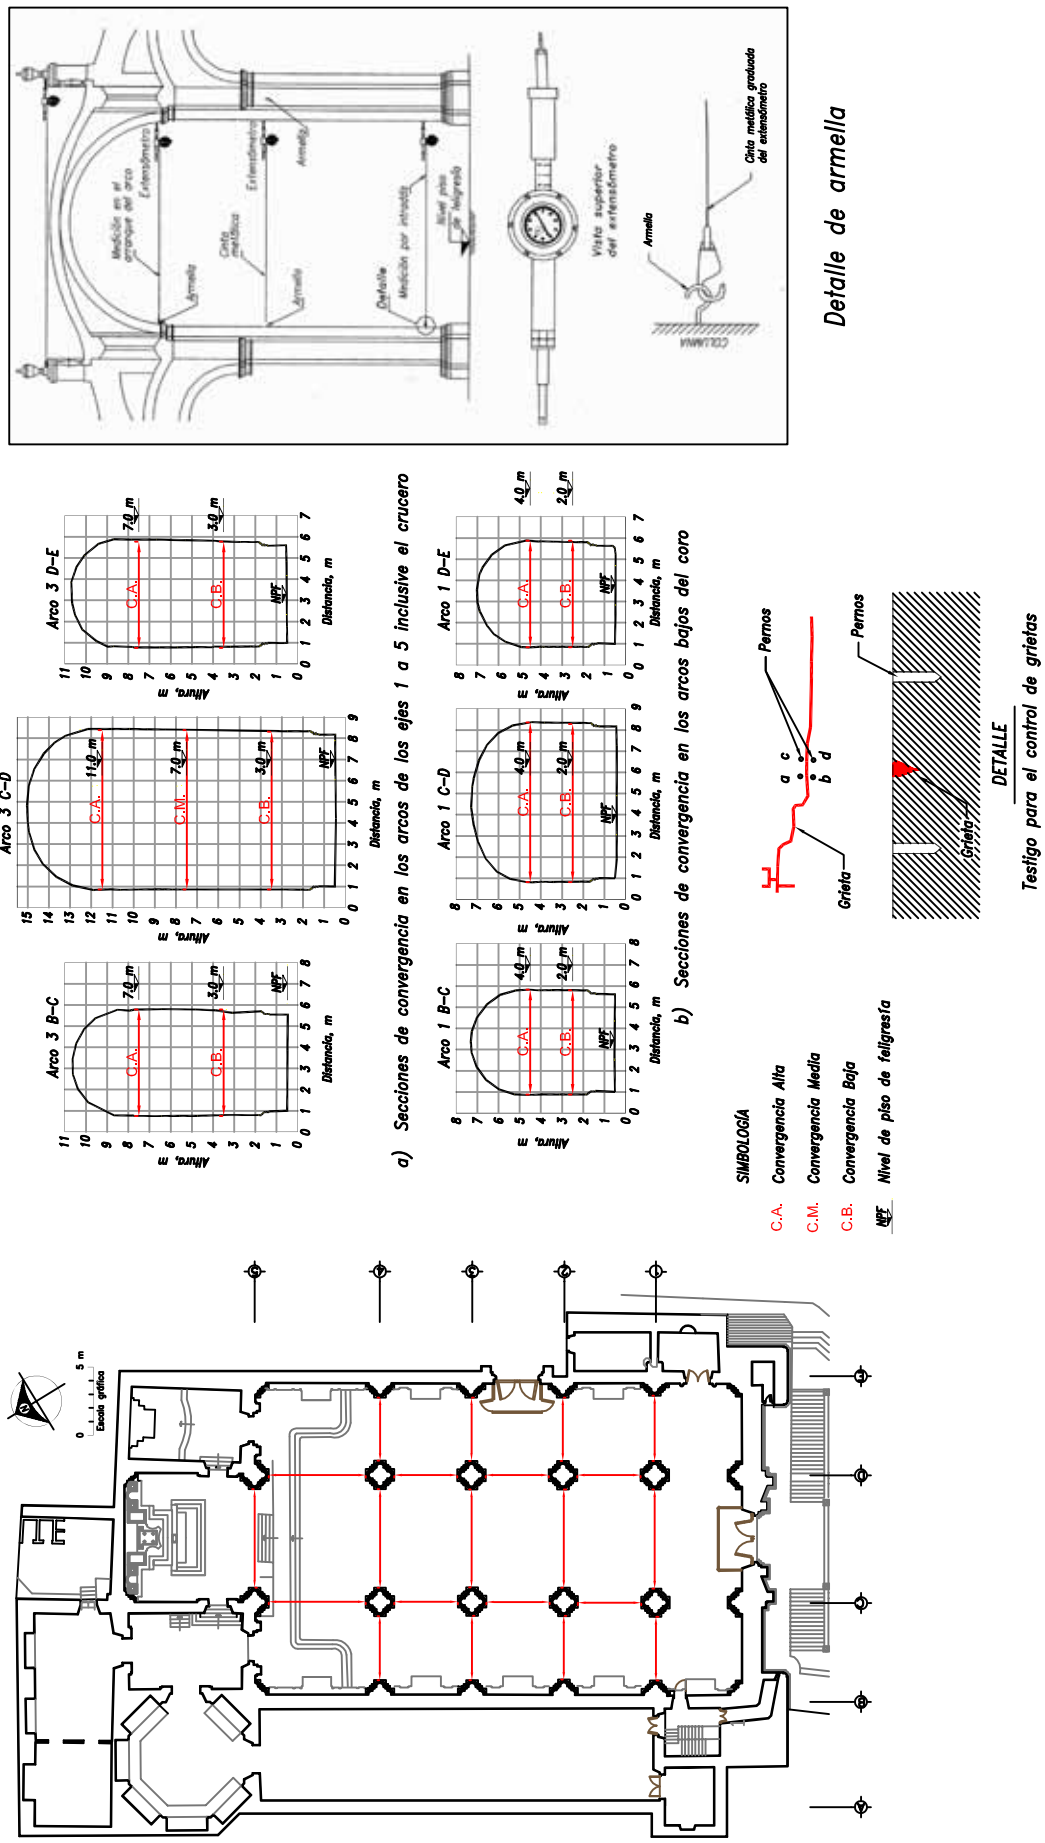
Ubicación de secciones de convergencia y detalle de testigos para el control de grietas
